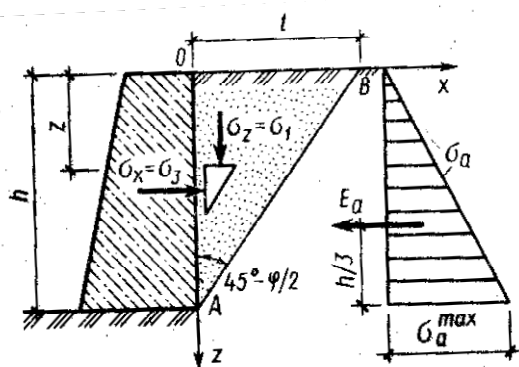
Схема для определения активного давления сыпучего грунта на гладкую стенку
